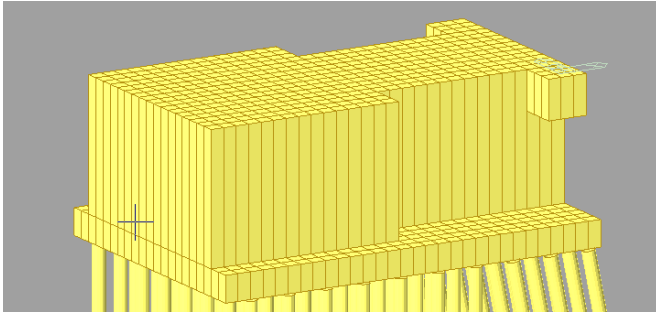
Pemodelan 3D Bangunan Atas dan Bawah
